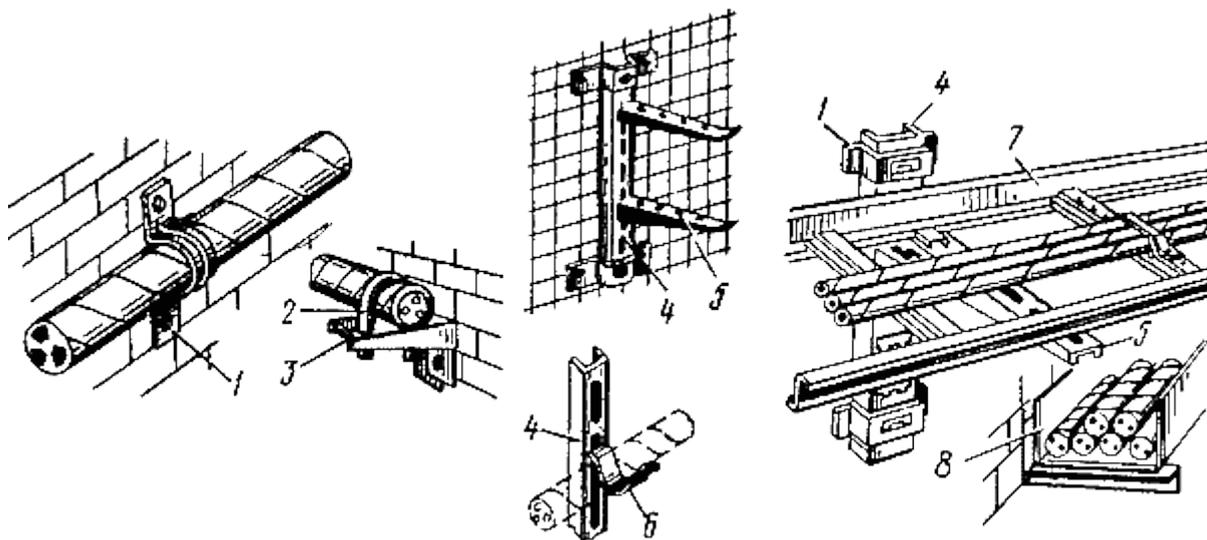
Прокладка кабелей в производственных помещениях: 1 - скоба; 2 - хомут; 3 - кронштейн; 4 - кабельная стойка; 5 - кабельная полка; 6 - подвеска кабельная закладная; 7 - лоток; 8 - короб
